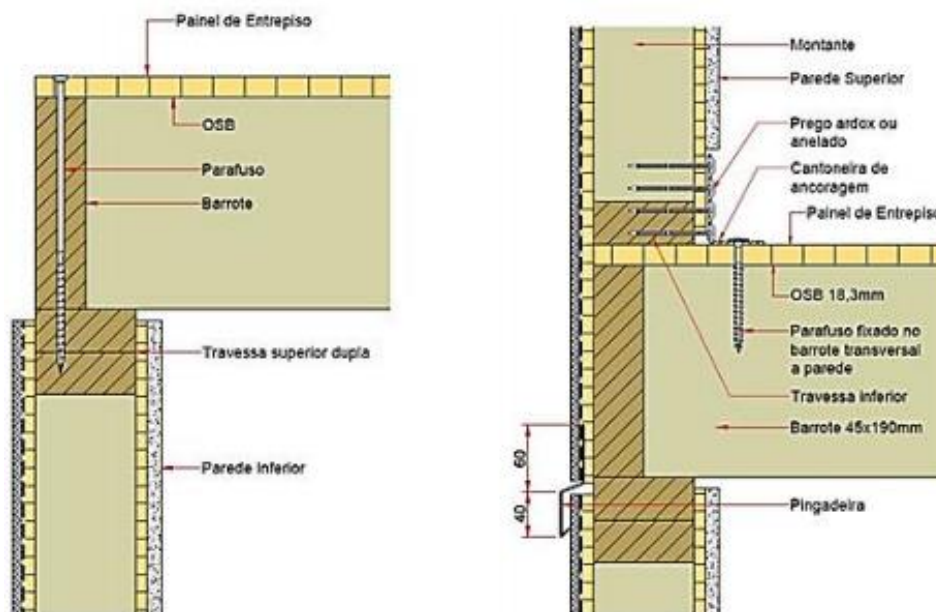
Detalhe de fixação do entrepiso na parede inferior [27]
